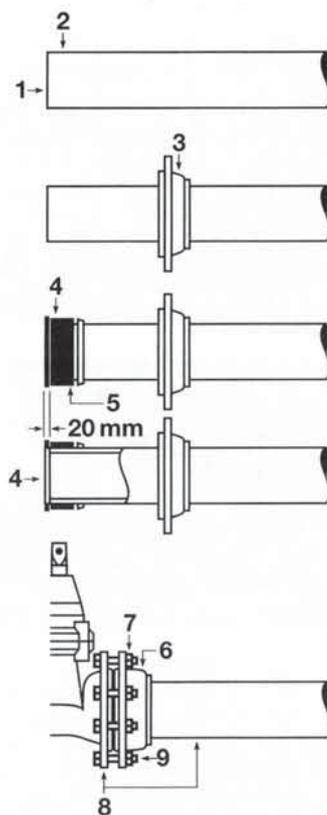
Схема присоединения устойчивого к растягивающим нагрузкам свободного фланца для ПВХ труб.
